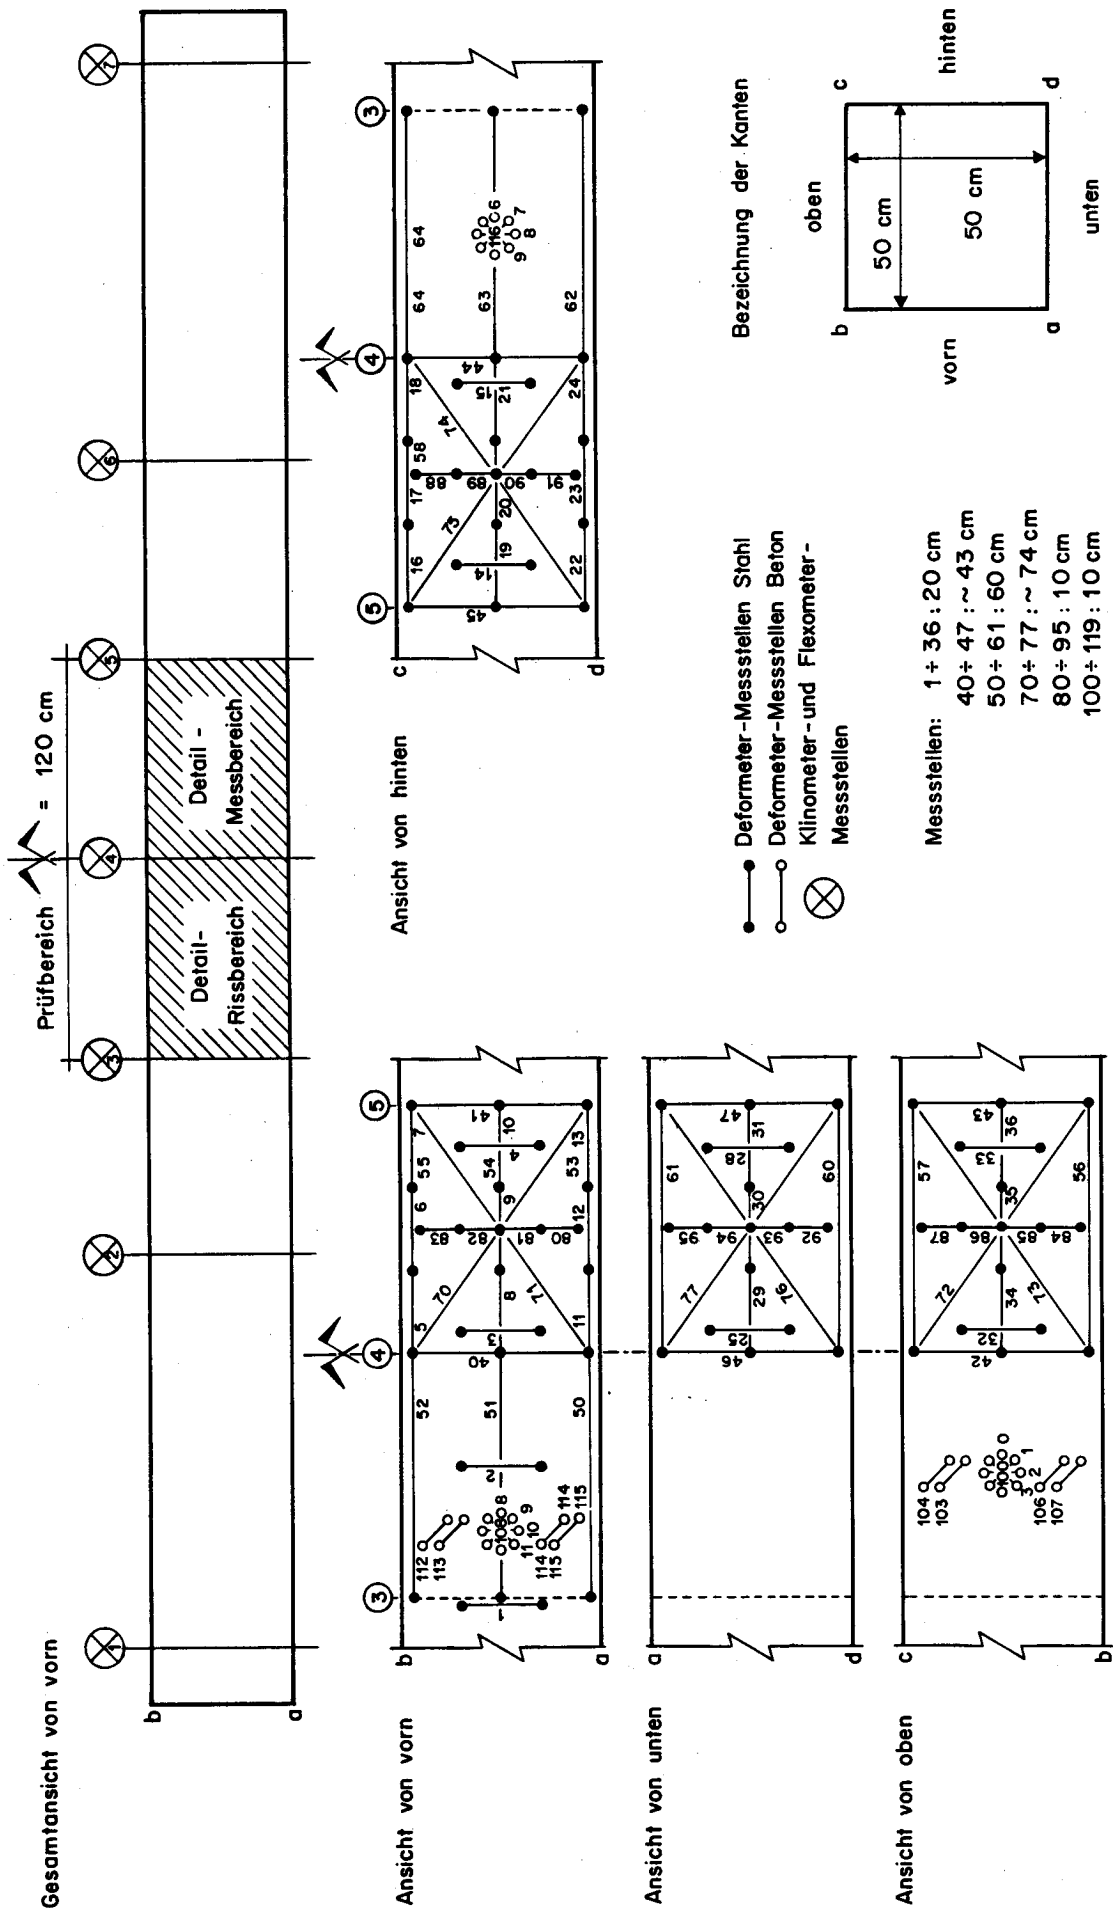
Messstellenplan der Balken TB₇ und TB₈
